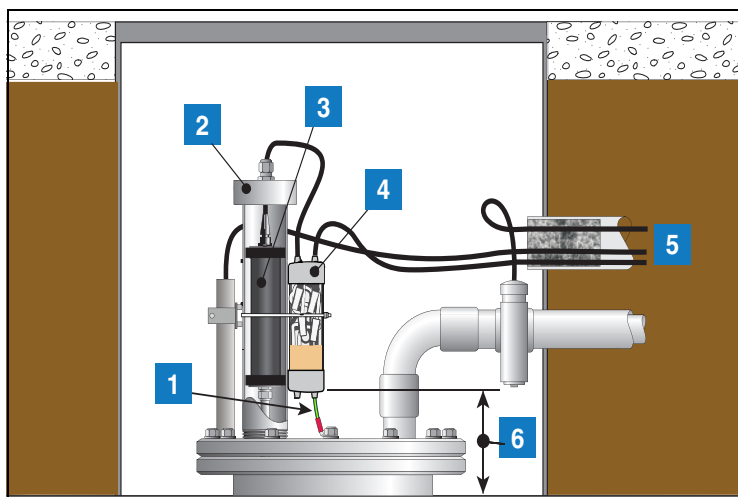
Esempio di installazione di tubo riser per sonda con protezione da sovratensioni
